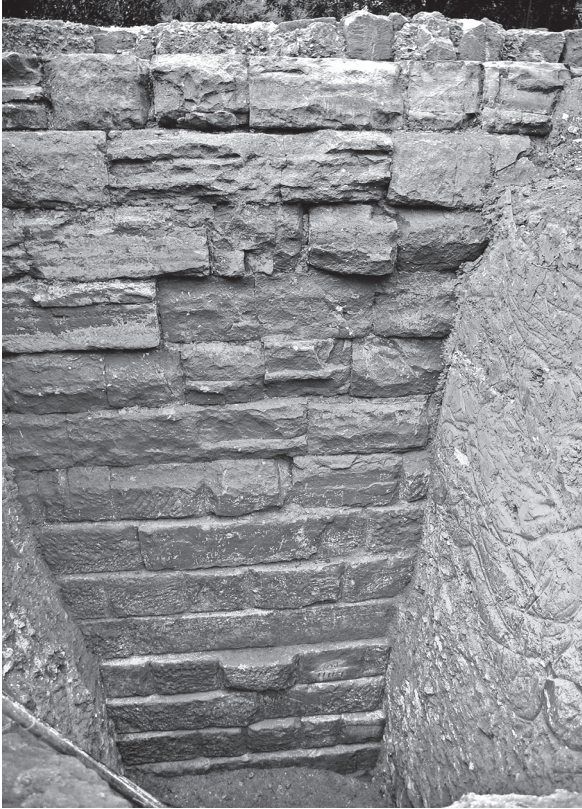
Pared interior (aguas arriba) de la presa. Se puede apreciar el estado y la conservación de los sillares en su zona inferior.
